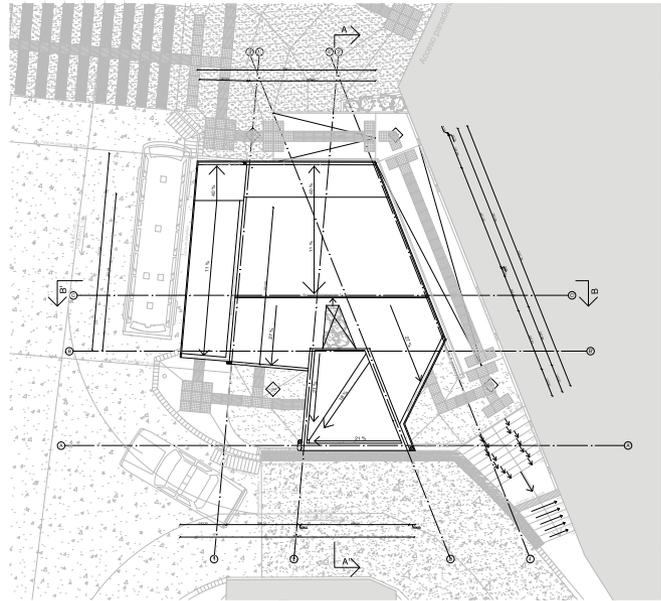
Planta techumbre, Intervención Plazuela Ecuador
